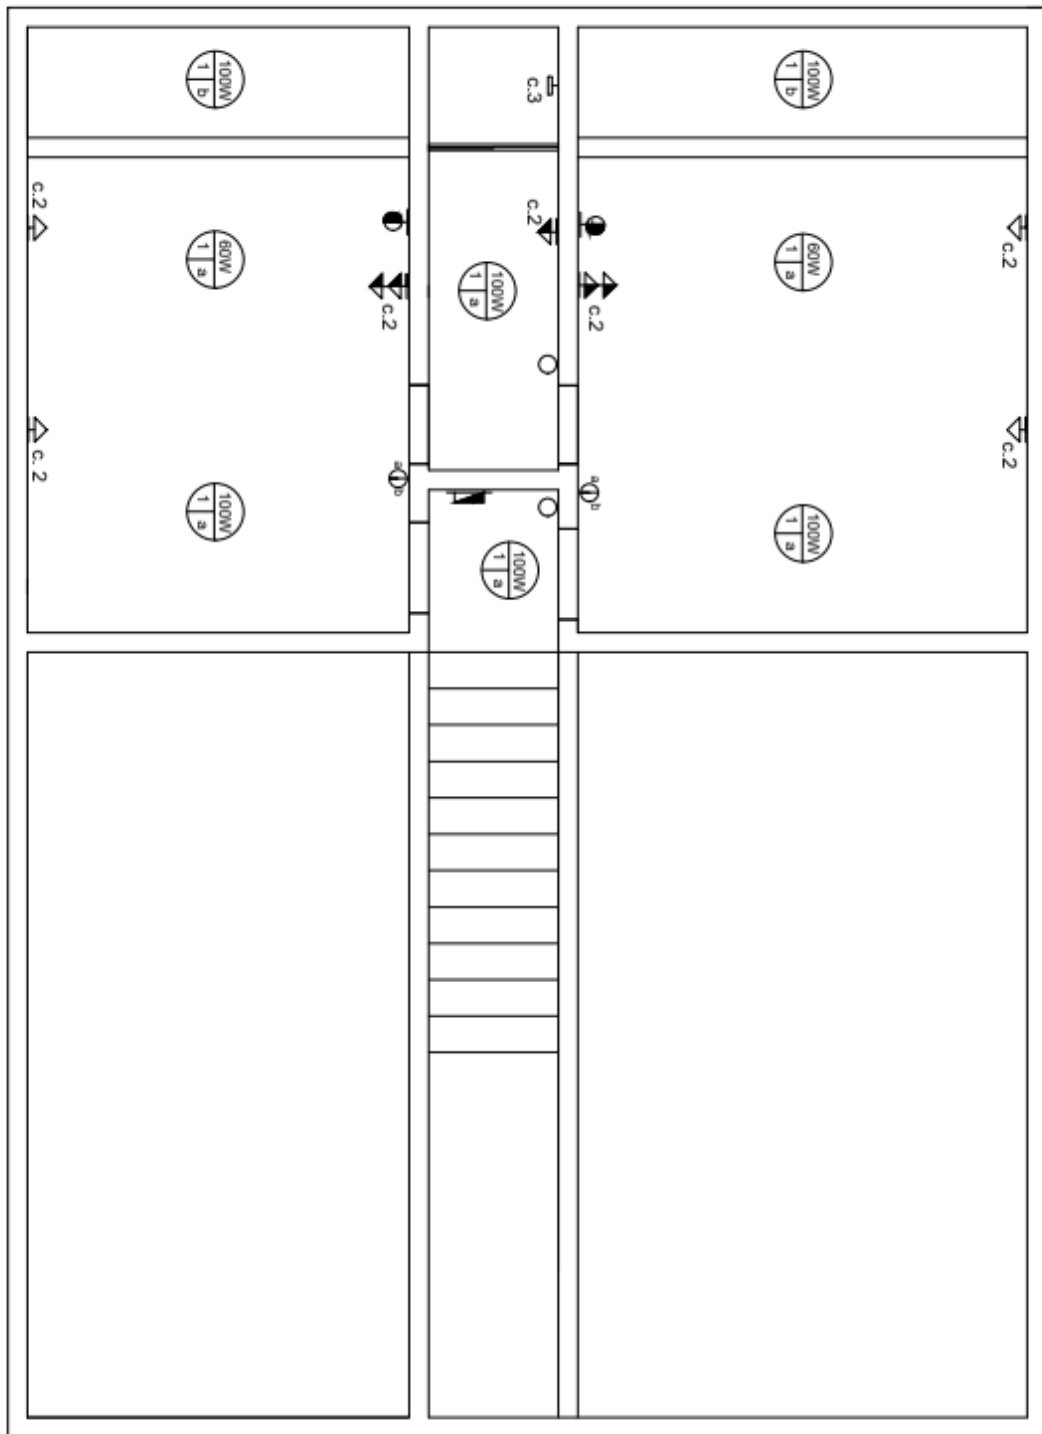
Planta baixa pontos de iluminação, tomadas e interruptores pavimento superior
